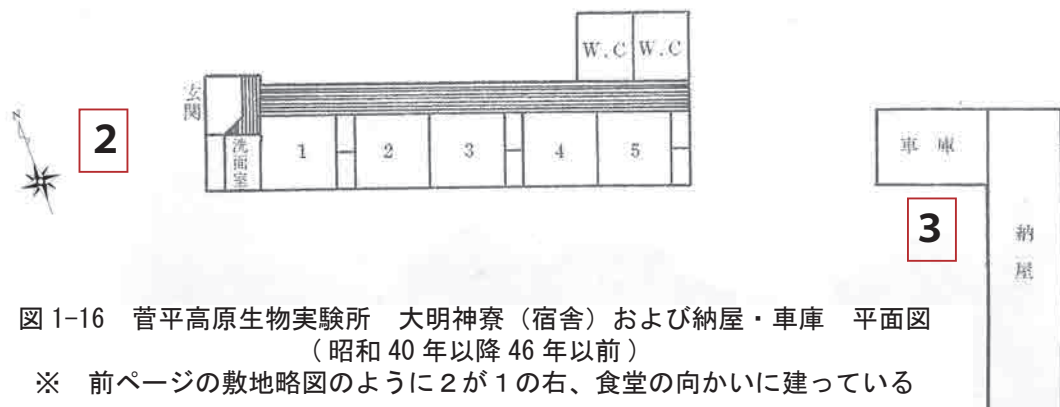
菅平高原生物実験所 大明神寮（宿舎）および納屋・車庫 平面図
